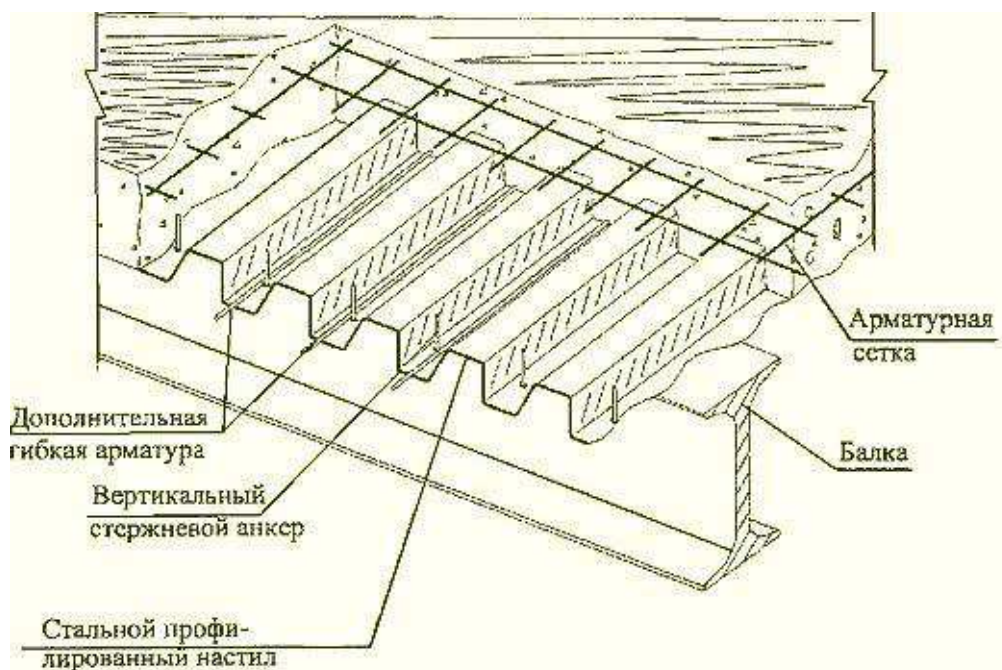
Конструкция монолитного перекрытия по профилированному настилу
